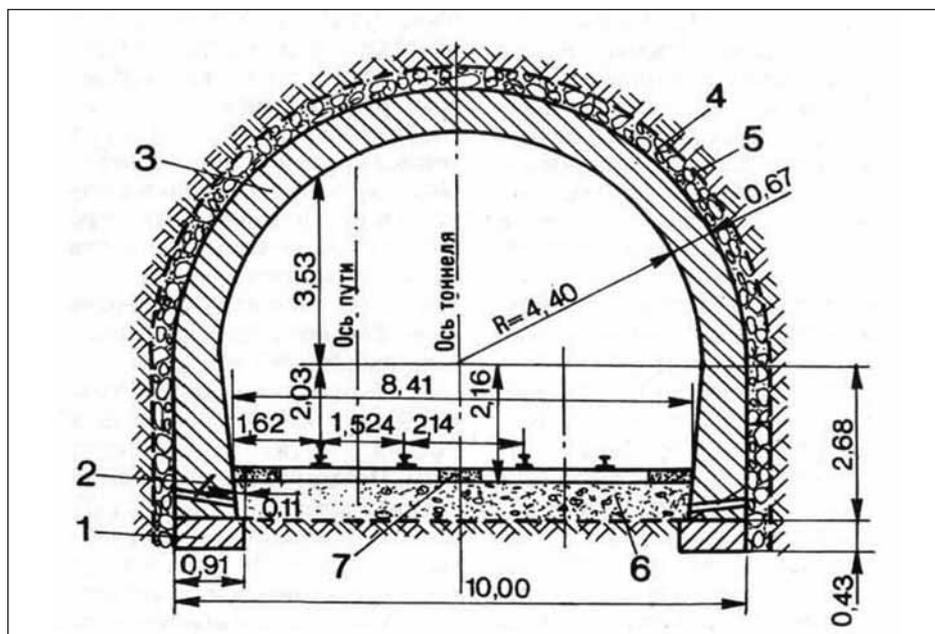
Поперечное сечение двухпутного Ковенского тоннеля (первого железнодорожного тоннеля в России постройки 1859–1862 гг.): 1 – фундамент стен; 2 – дренажные трубы; 3 – кирпичная (каменная) кладка; 4 – заполнение камнем или кирпичным боем; 5 – грунт; 6 – песчаный балласт; 7 – щебень (размеры указаны в метрах)
